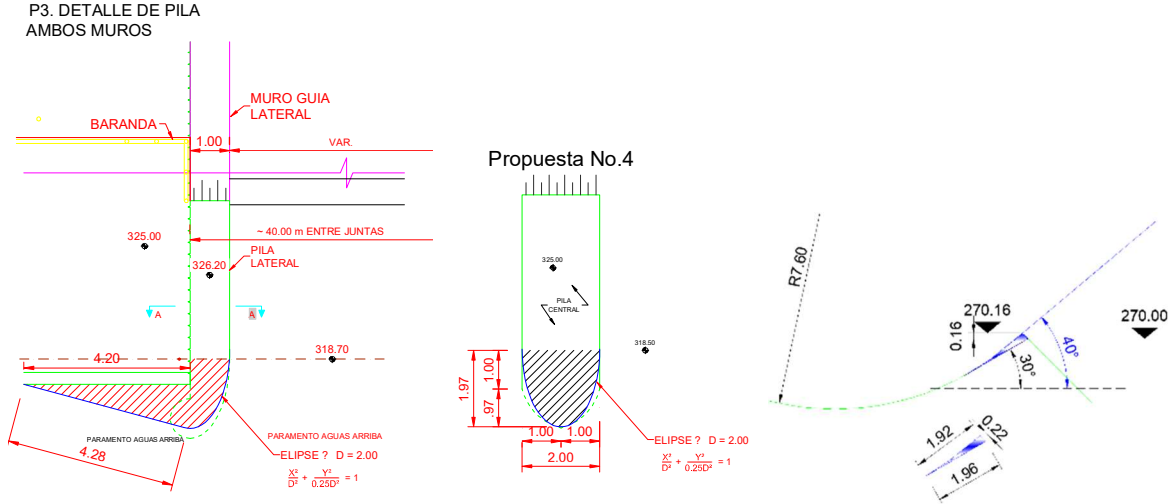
Vista en planta de la geometría de modificación de pilas laterales y centrales, y modificación del labio del deflector central propuestas para la serie 8.
